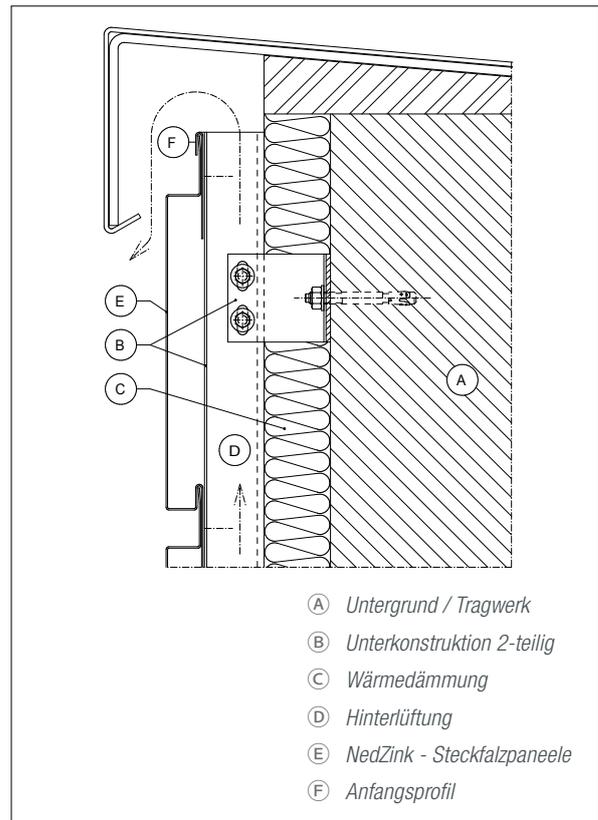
Steckfalzpaneele oberer Fassadenabschluss
